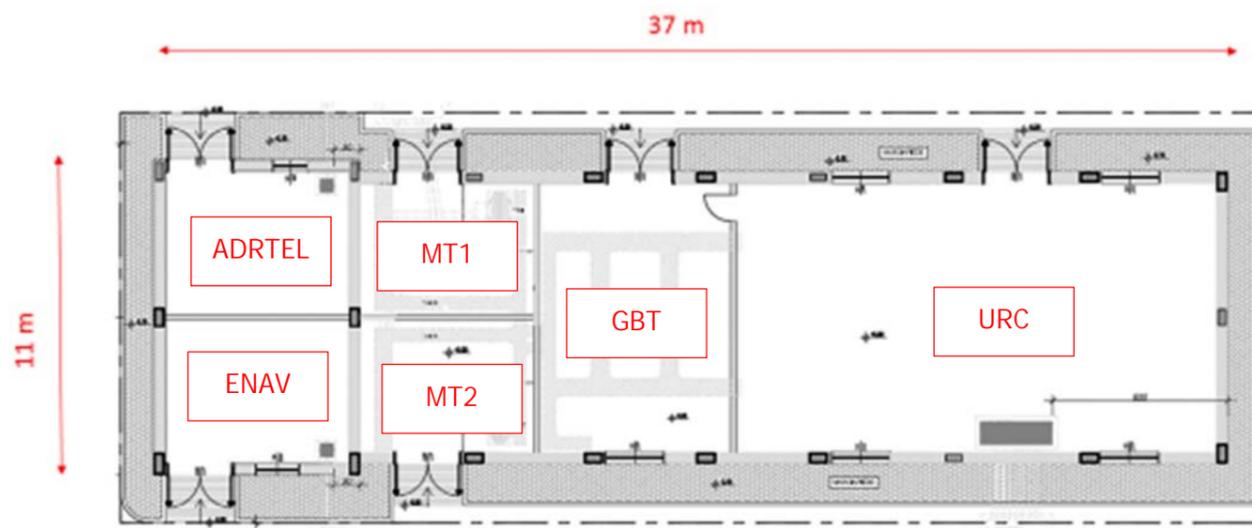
Vista in pianta delle cabine AN18 e AN19
